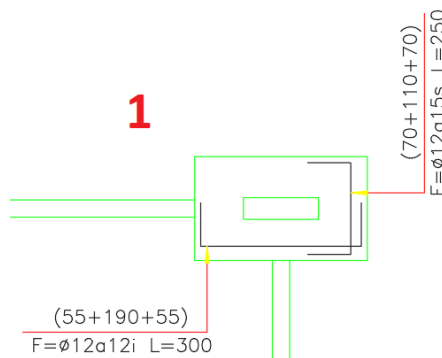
Ejemplo armadura de fundación tipo zapata aislada.
